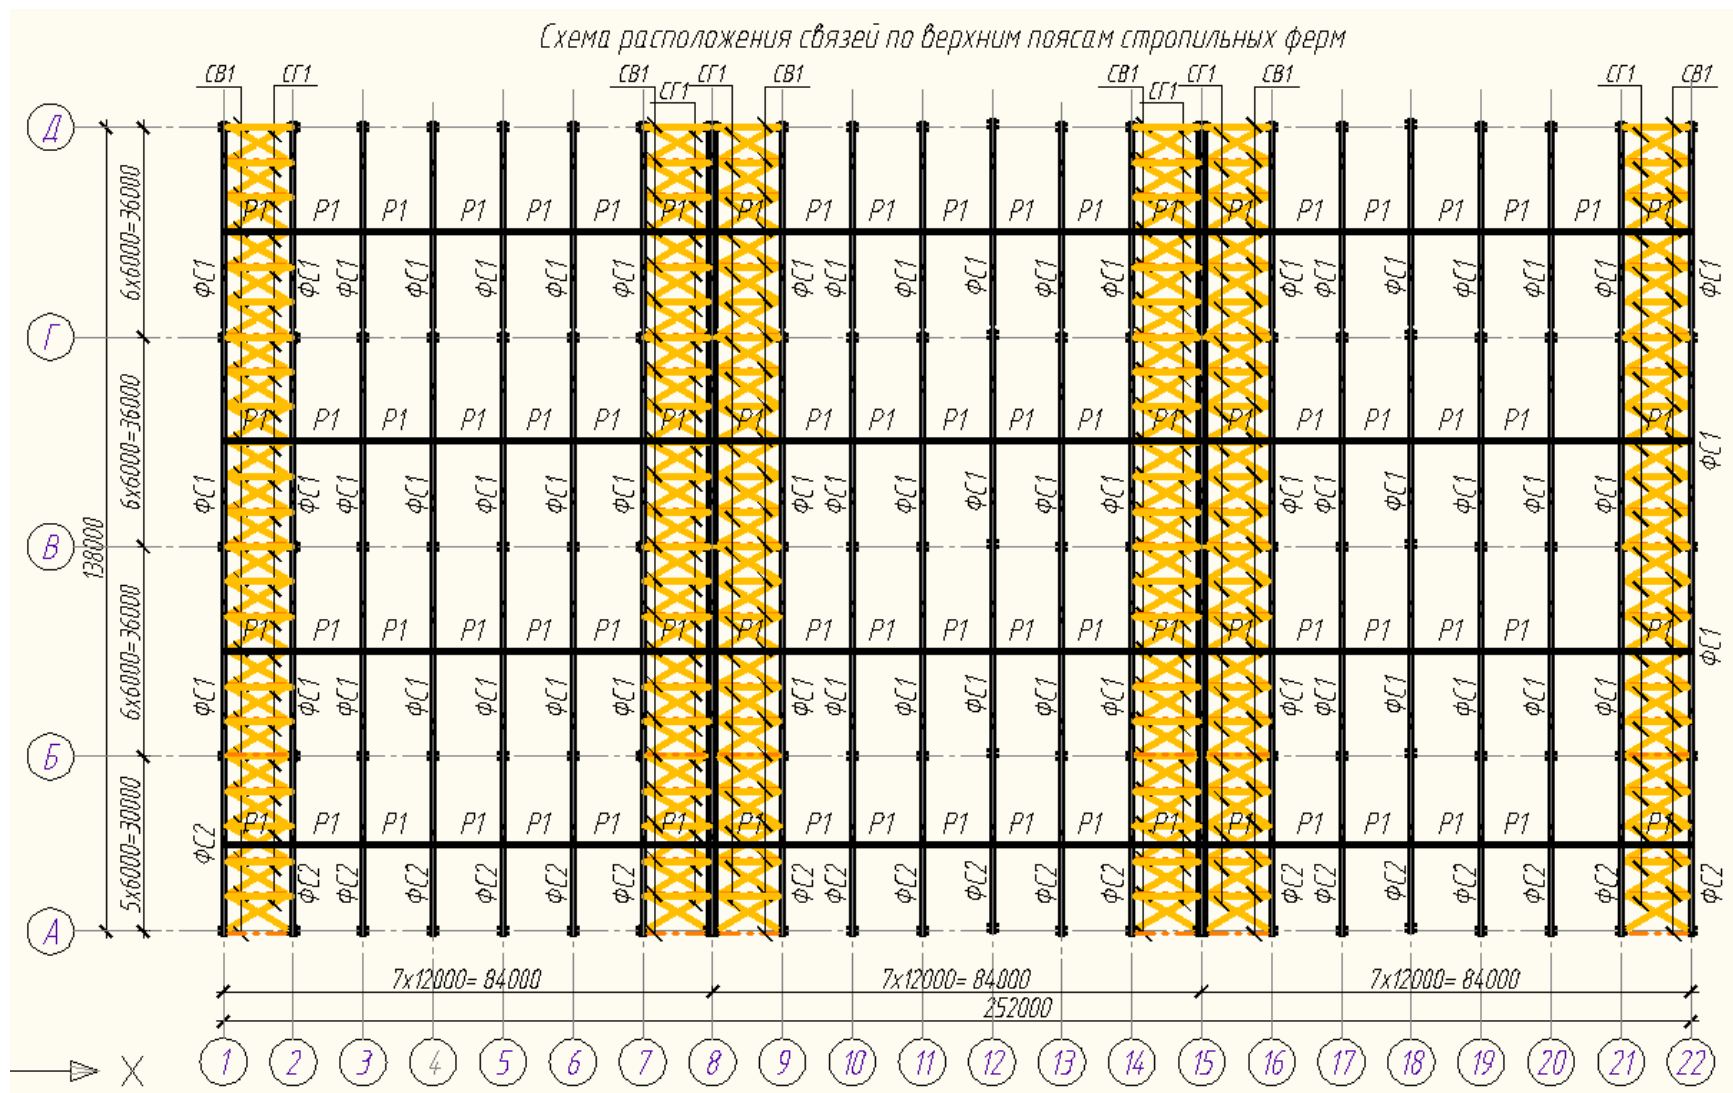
Схема расположения связей по верхним поясам стропильных ферм
